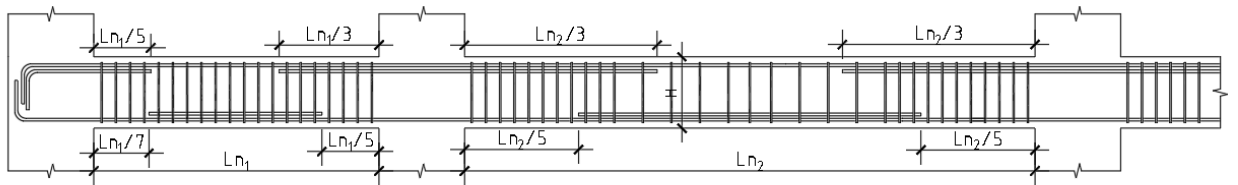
Corte aproximado de acero en vigas y losas para cargas de gravedad.
